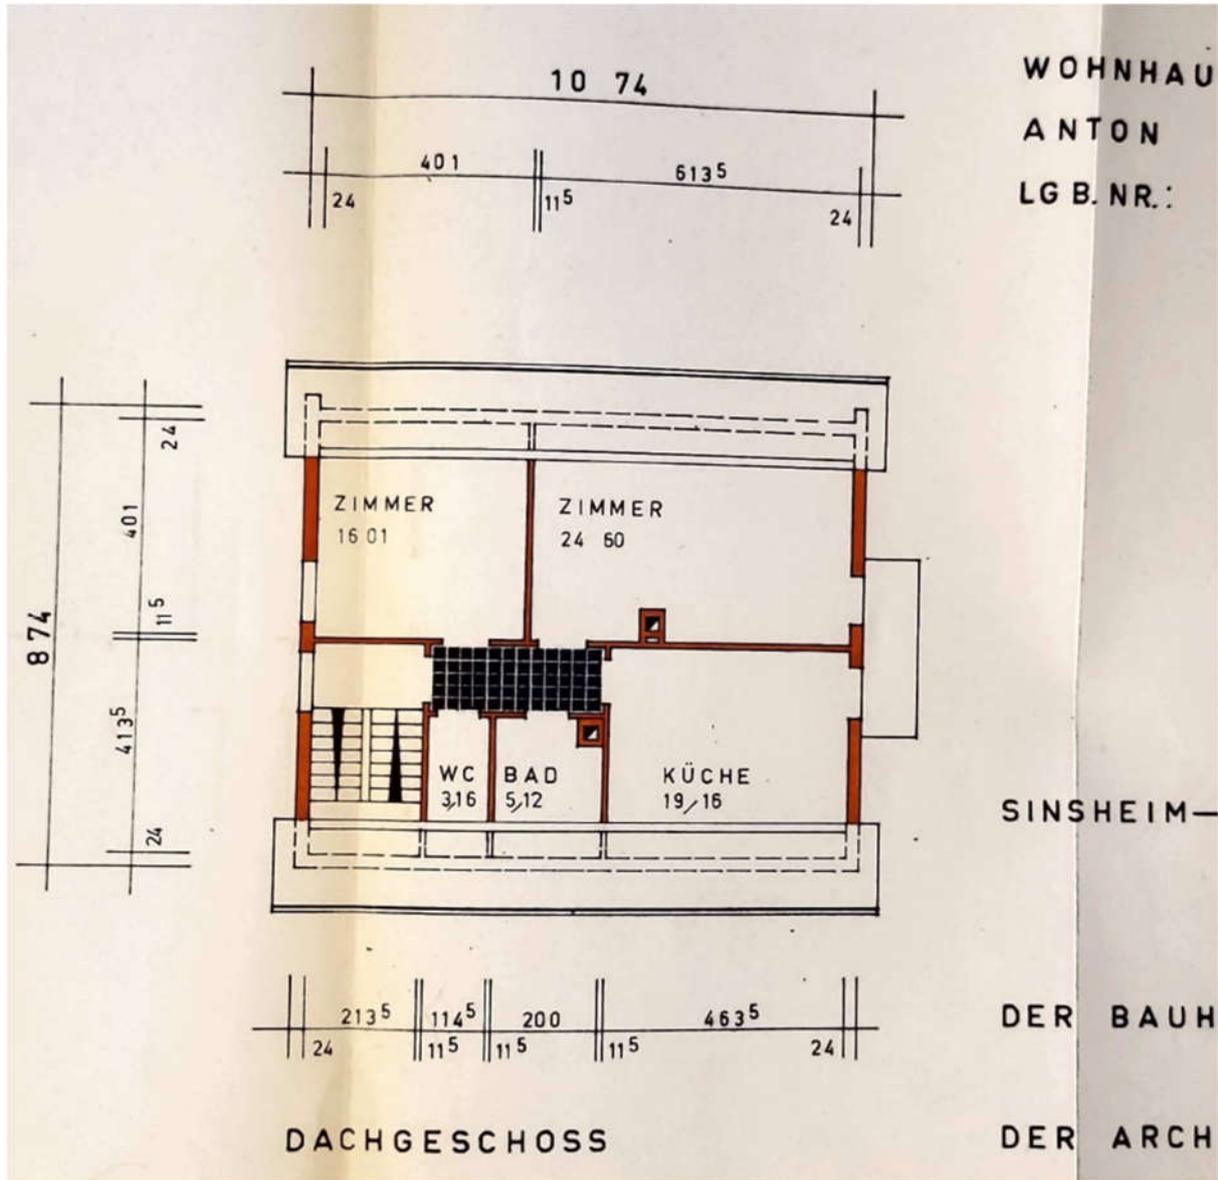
Grundriss Dachgeschoss Ursprung ohne Erweiterung
